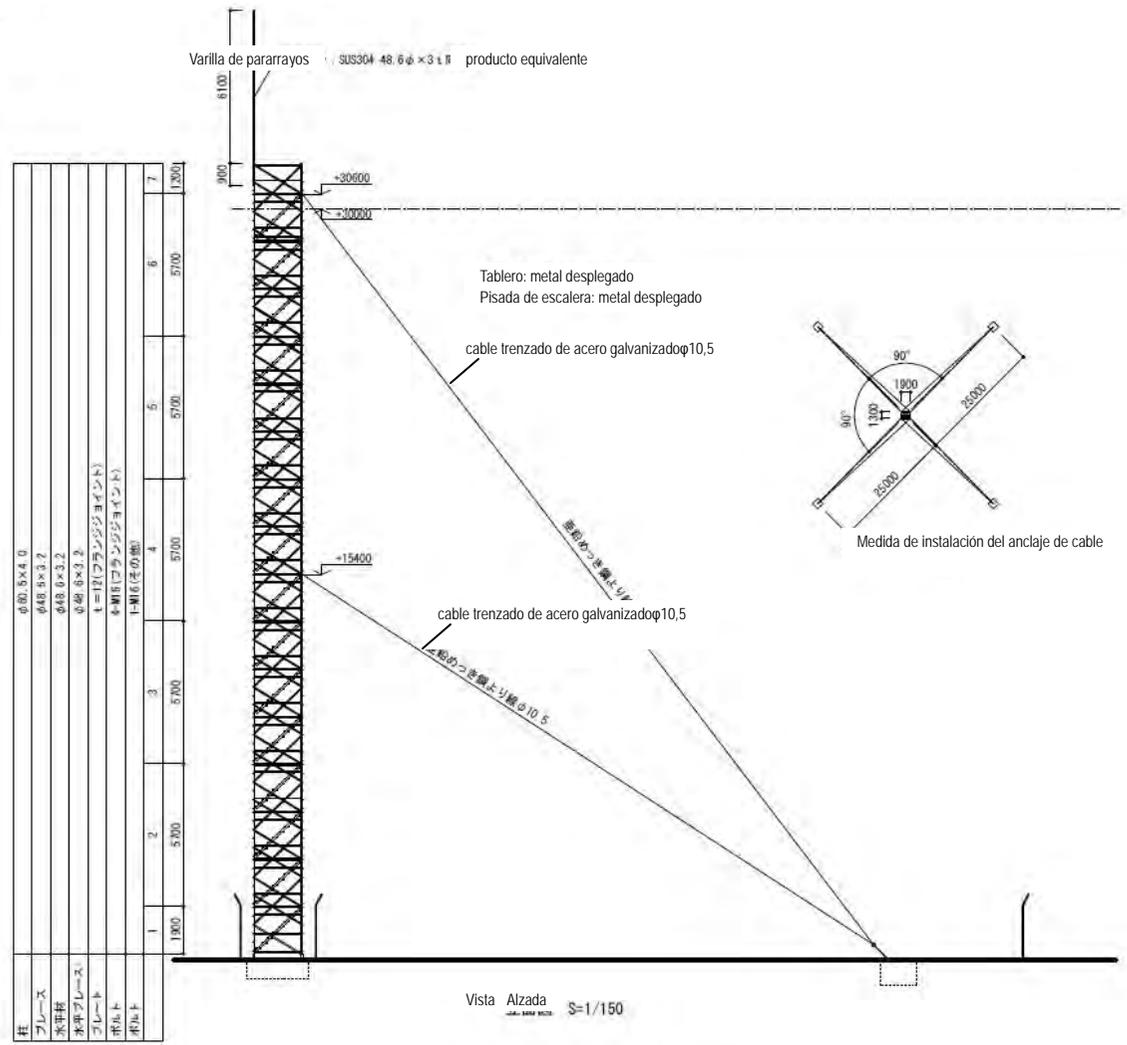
Vista Alzada de la Torre (h=30m) (plano referencial)
